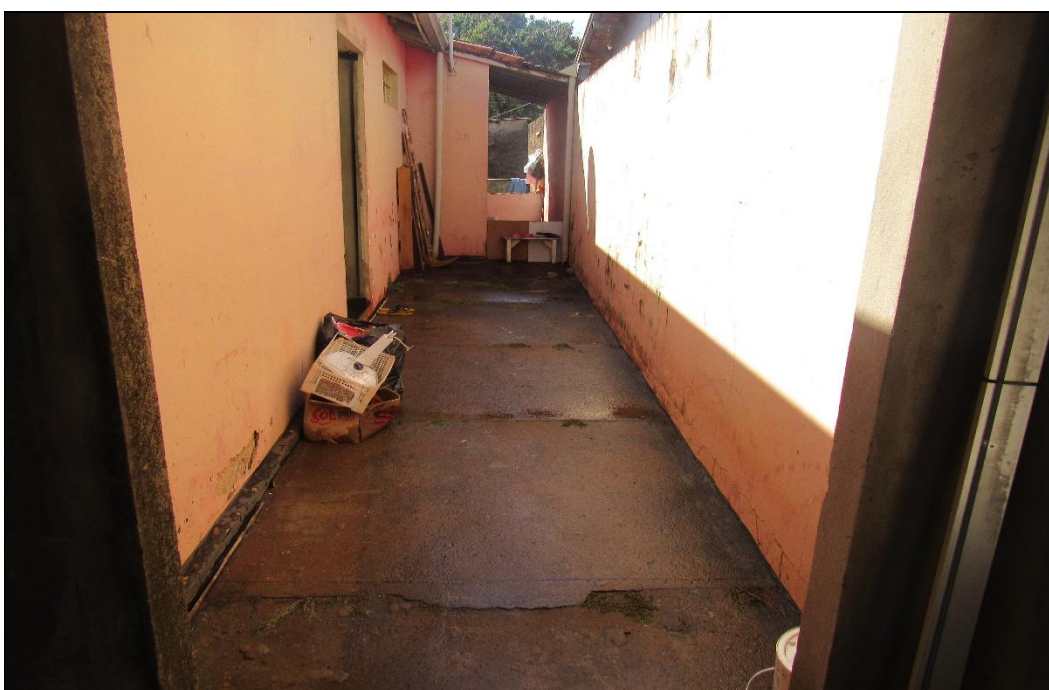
Vista do corredor lateral do imóvel. Nota-se umidade na parede inferior.
